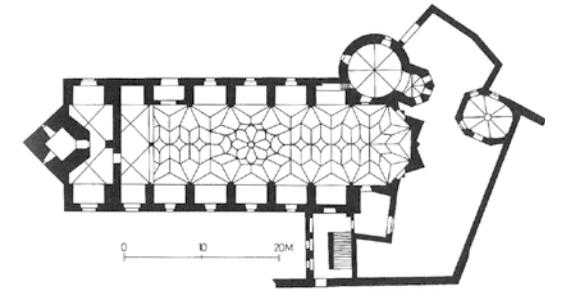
Grundriss Dehio Niederösterreich 1990, 863. M 1:1000.
